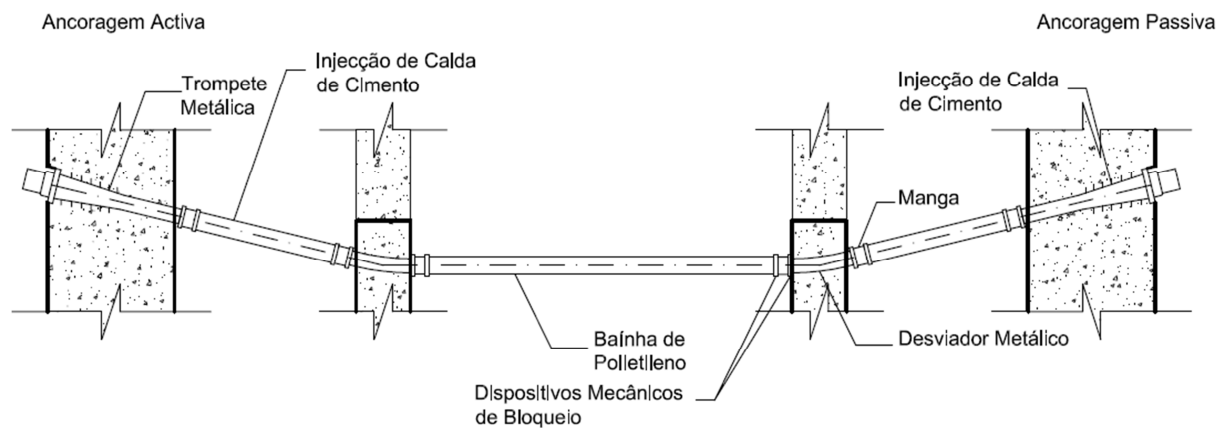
Sistema de pré-esforço exterior aderente.
